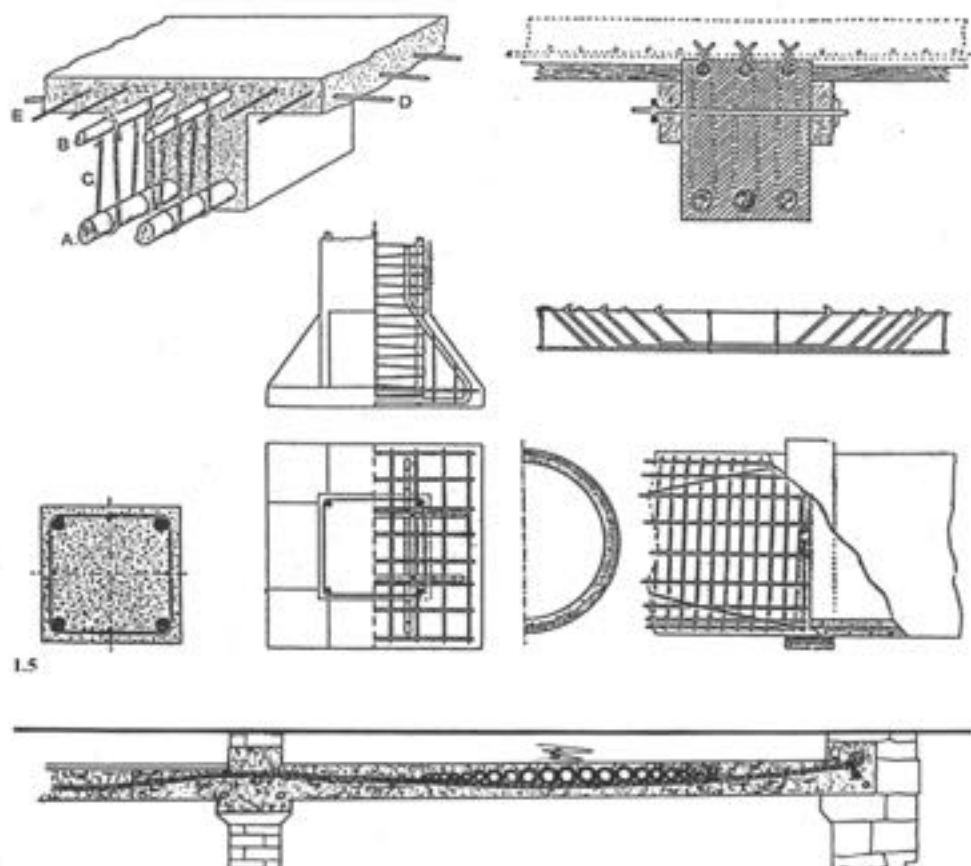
| William Boutland Wilkinson, disegno dal suo brevetto per la costruzione mista ferro-calcestruzzo persola, 1854, in Kind-Barkauskas Friedbert. "Atlante del cemento", Torino, UTET, 2000.
